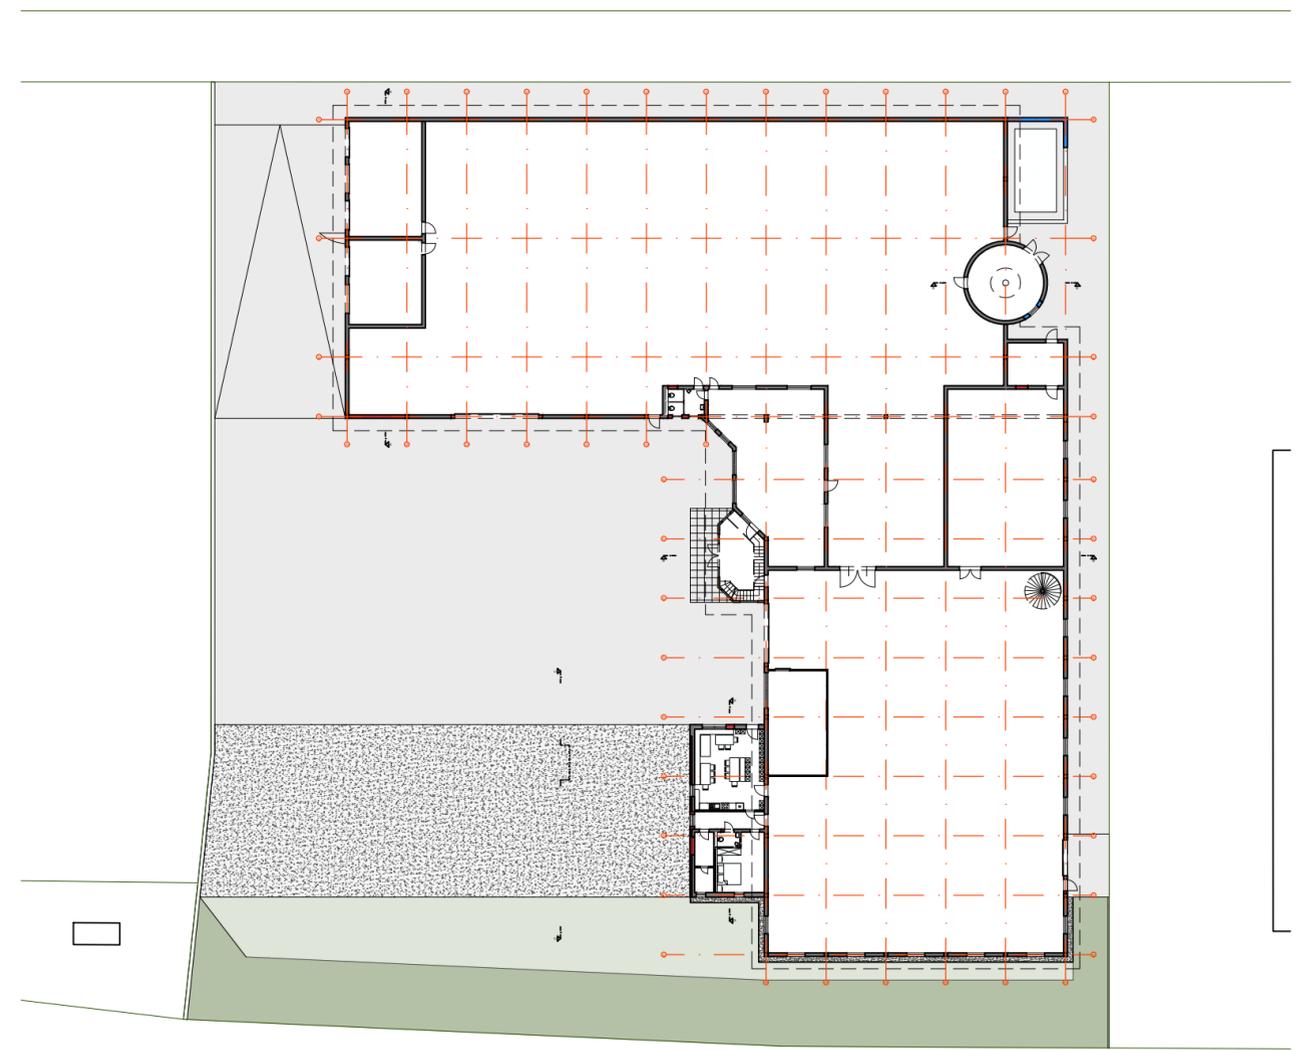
Einreichung Auswechslung - Grundriss Erdgeschoß
